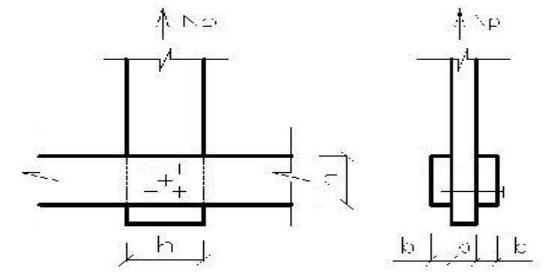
Гвоздевое соединение вертикальной стойки и двух горизонтальных досок
